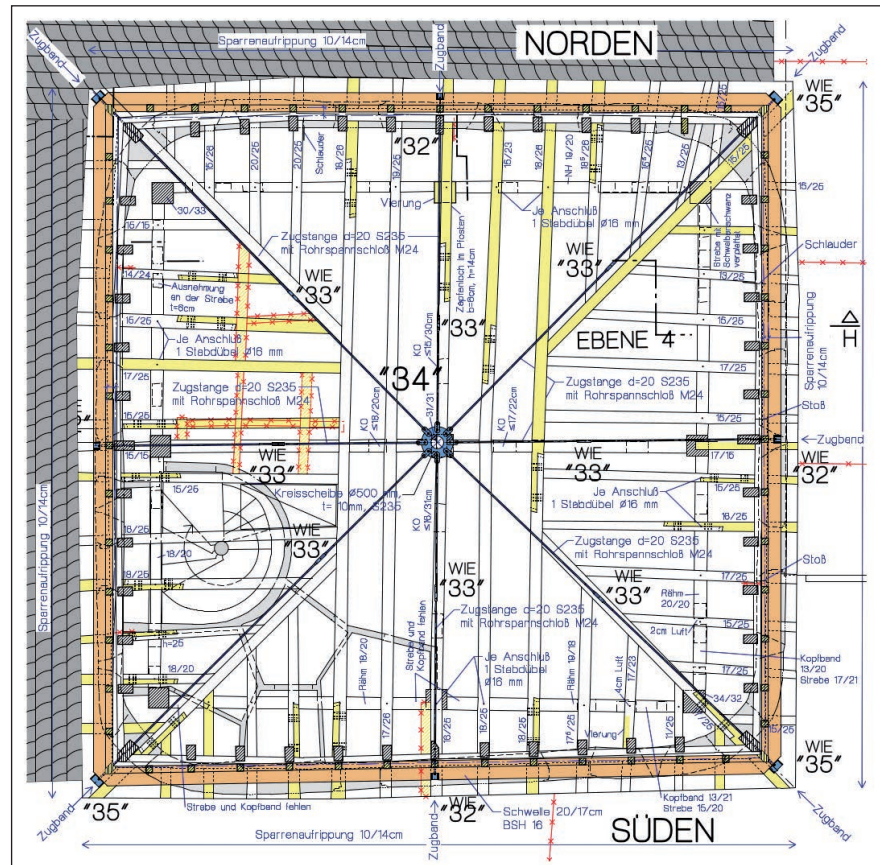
Grundriss der Ankerbalkenlage des Bergfrieds – Maßnahmenplan.
